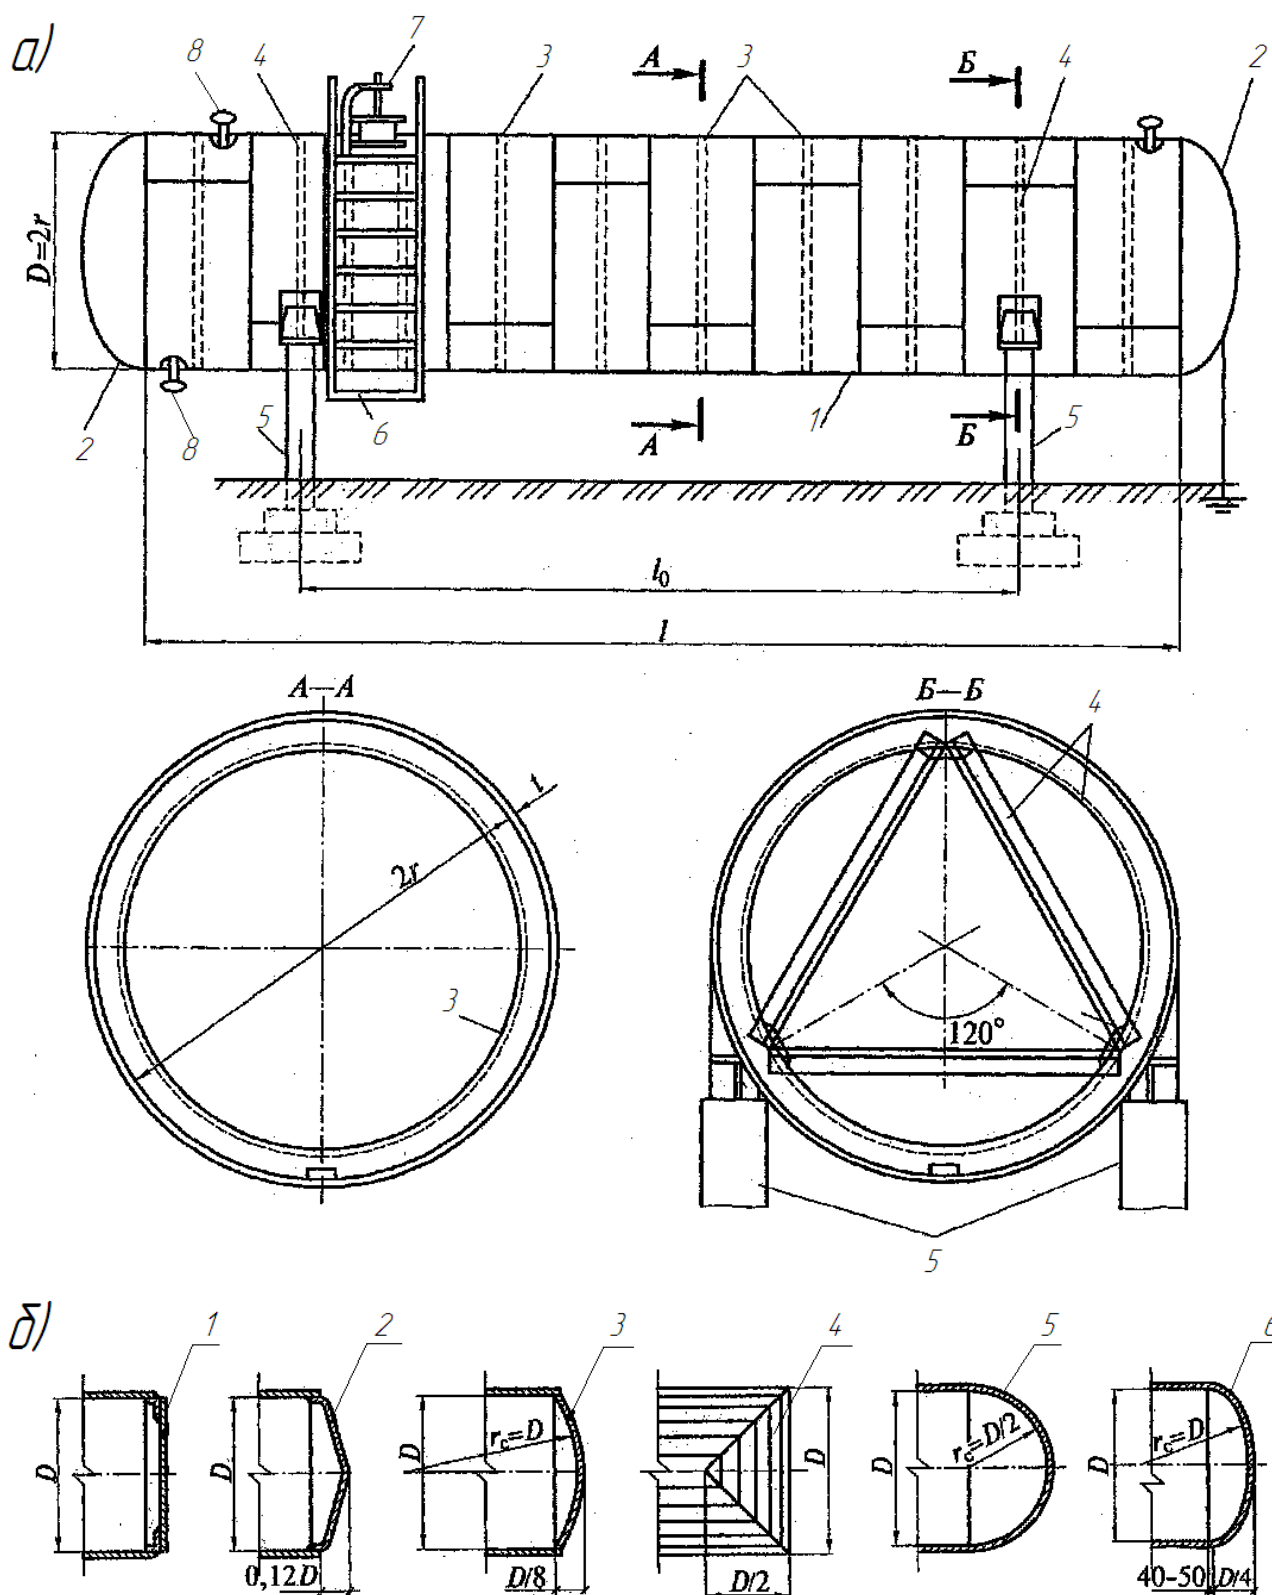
Горизонтальный цилиндрический резервуар:
